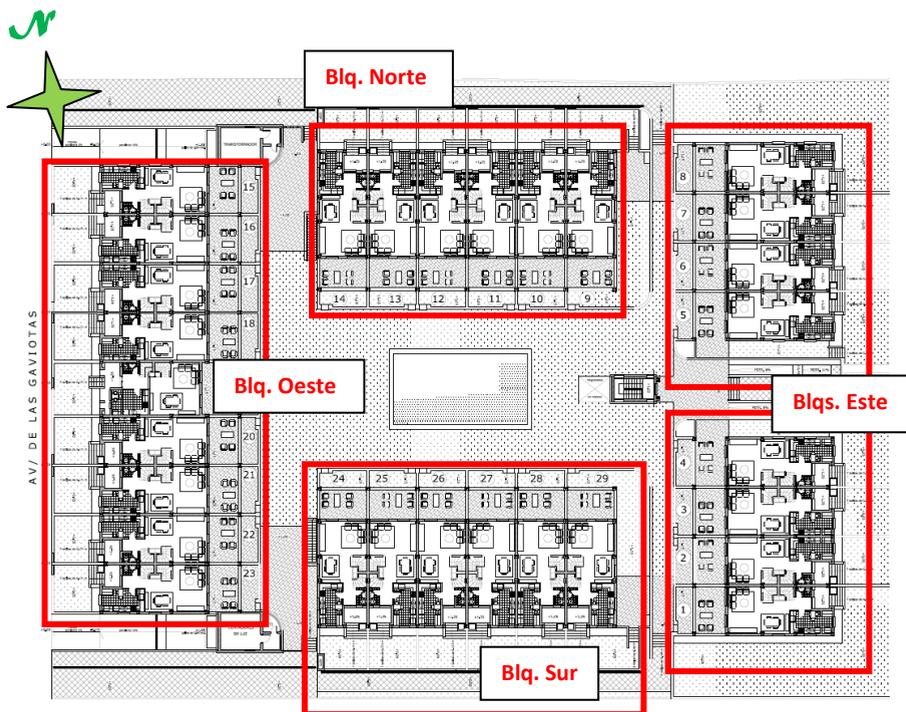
Distribución general planta baja. P. Ejecución 2006
